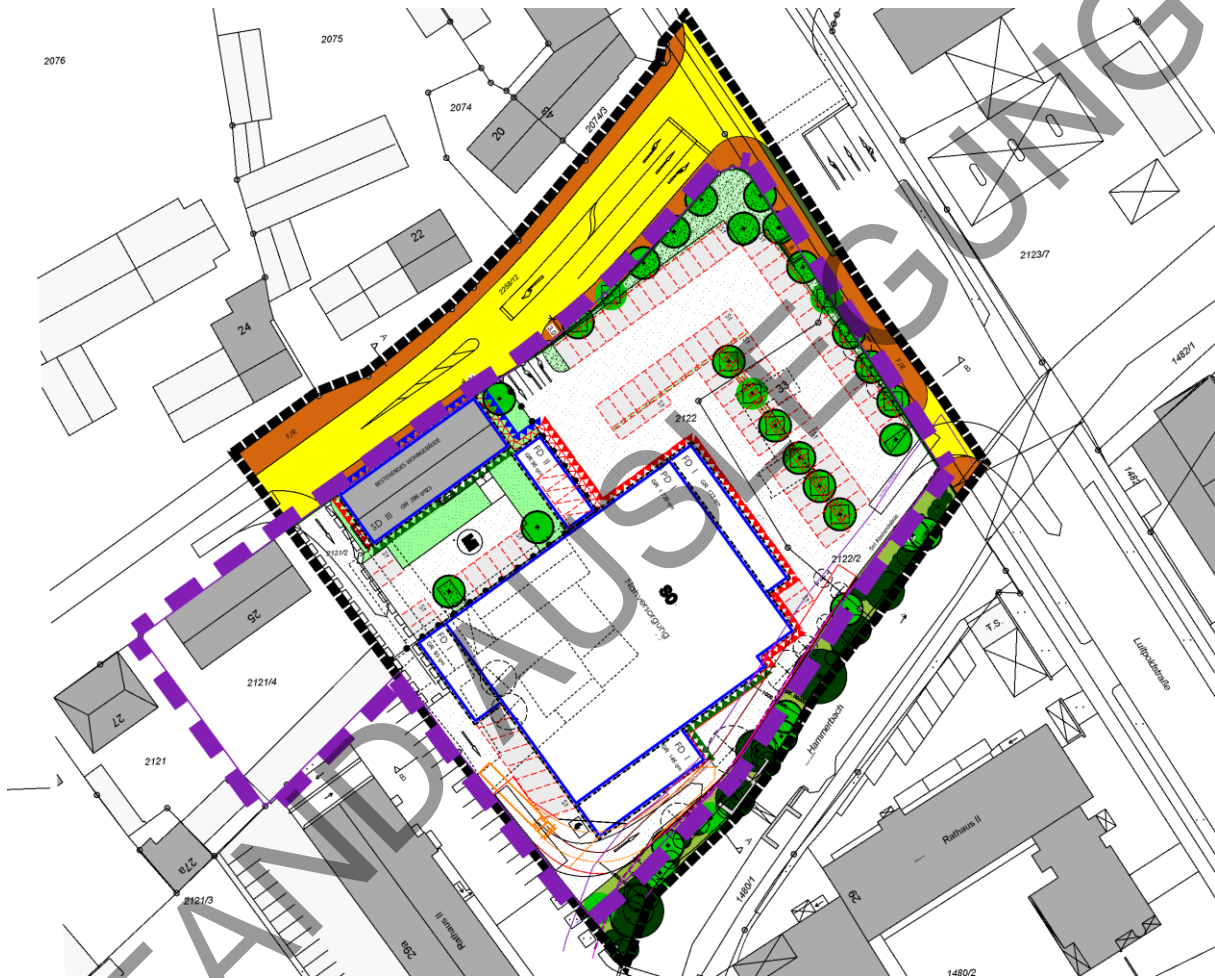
Ur-Bebauungsplan 02-13, überlagert mit Geltungsbereich der 1. Änderung (violett), unmaßstäblich
